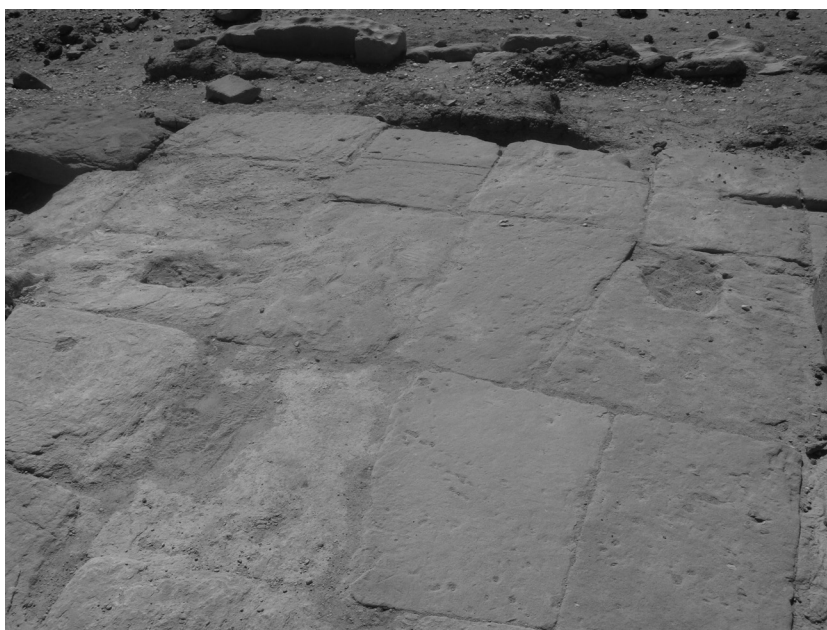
tracés de pose de la salle à l'ouest de la salle latérale sud.
